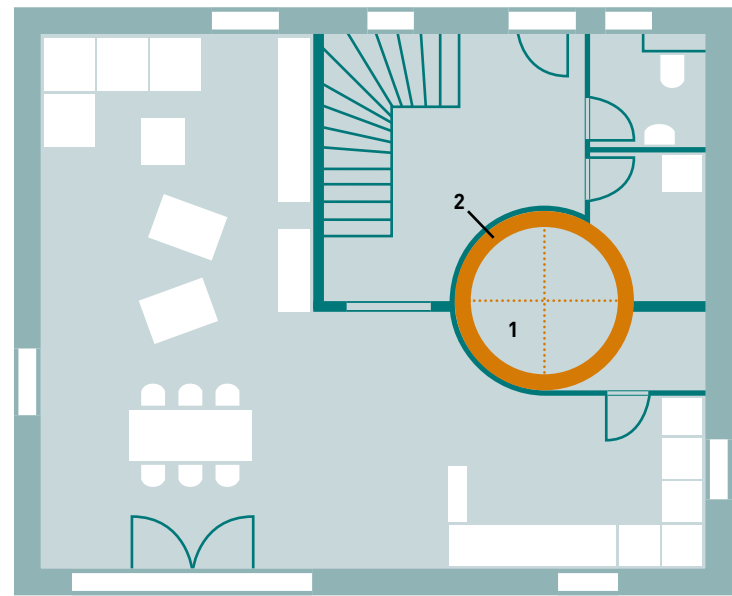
Grundriss eines Solarthermiehauses mit eingetragenen Komponenten
